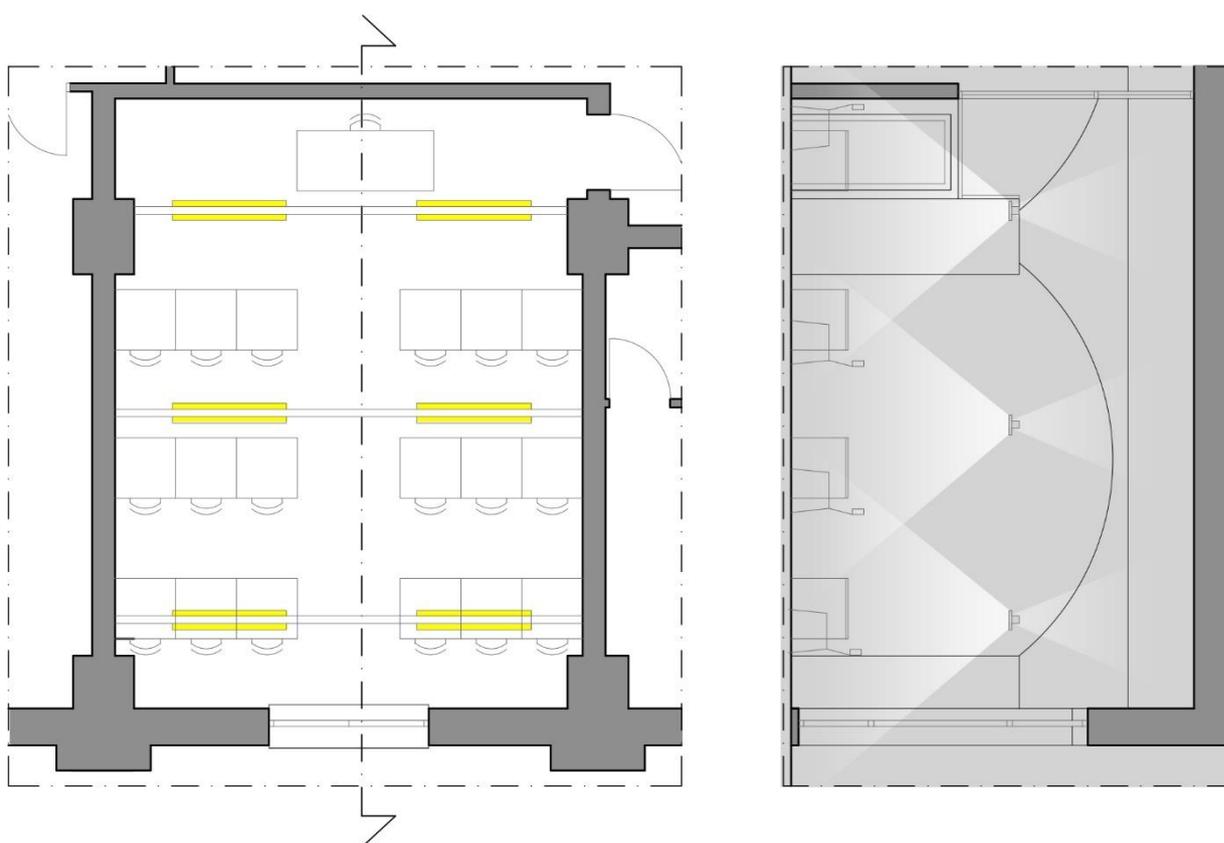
Pianta e sezione fuori scala dell'aula tipologia 1 con disposizione dei banchi e degli apparecchi.
